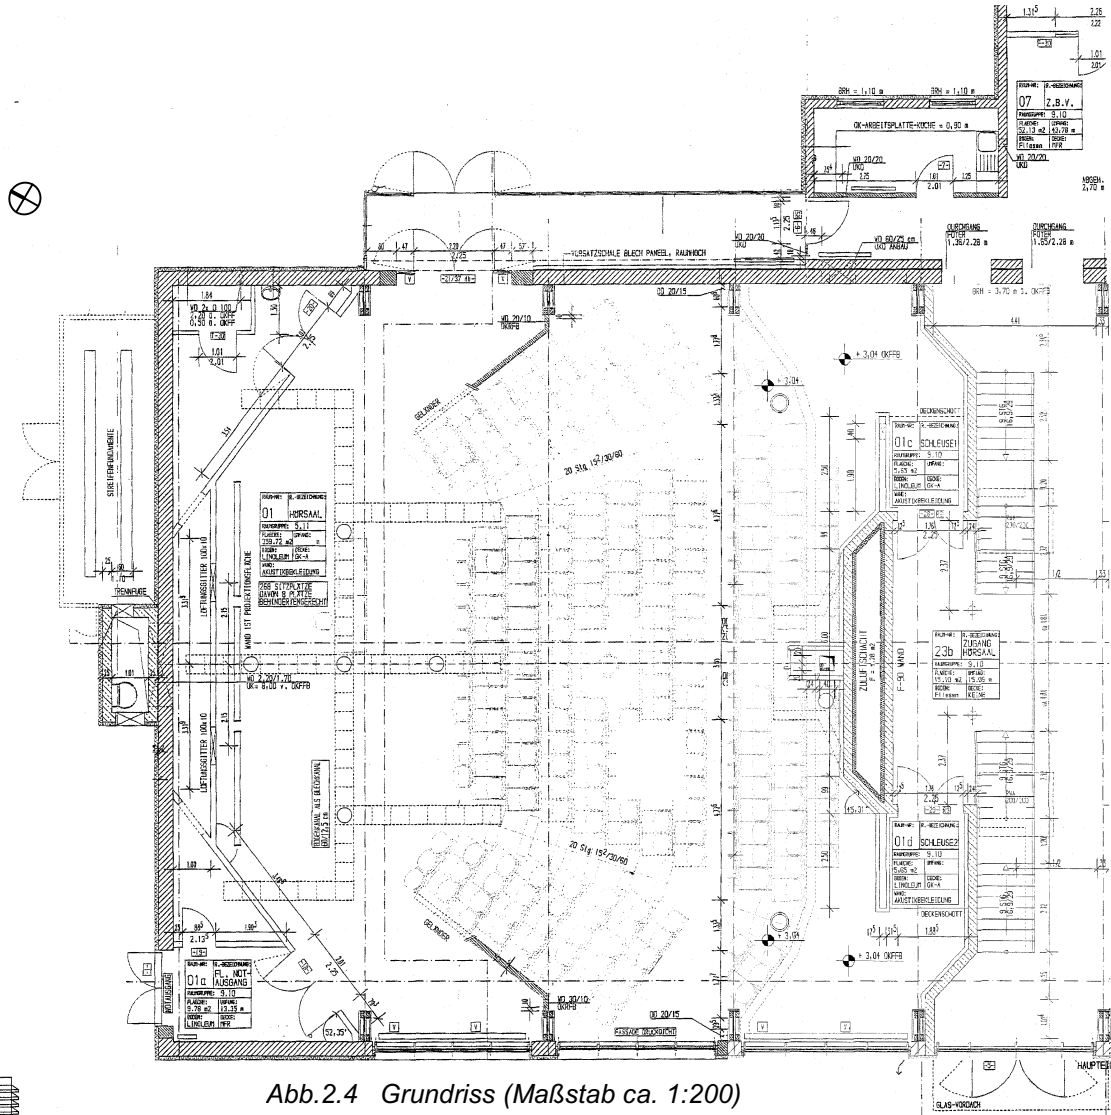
Grundriss (Maßstab ca. 1:200)
